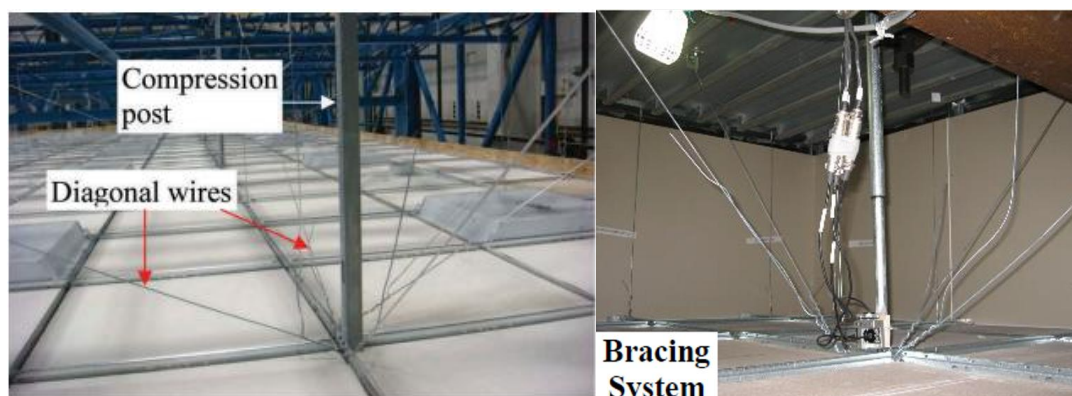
Instalação de contenções laterais. Adaptado de ([35] e [66])
